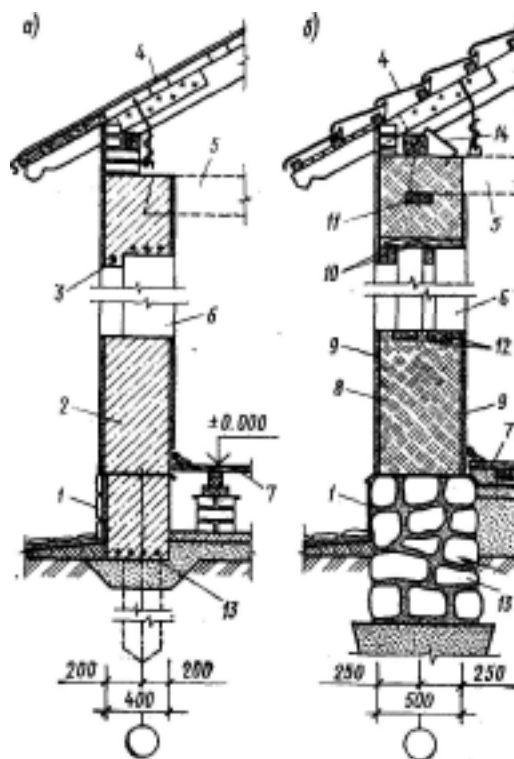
Разрезы наружных стен одноэтажных жилых домов из местных материалов:
